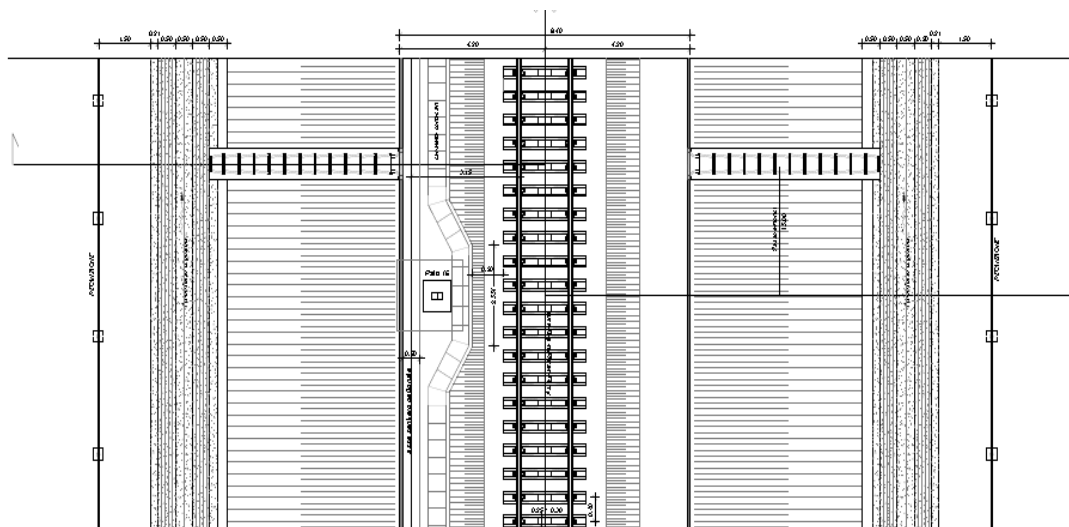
Stralcio planimetrico per sezione tipo ferroviaria in rilevato a singolo binario (piattaforma in retto) con  $H_{ri} \leq 6,00$  m
